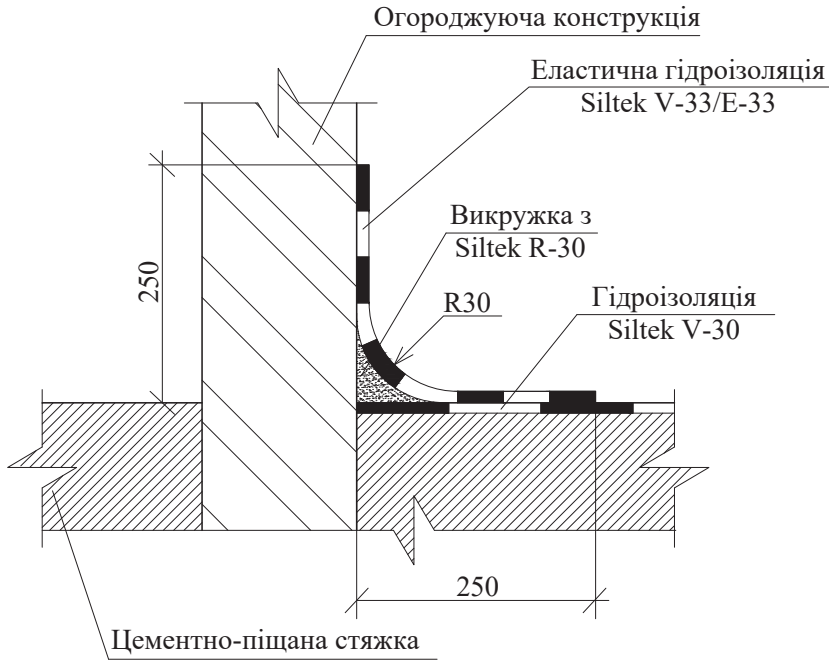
Схема влаштування гідроізоляції на стиках конструкцій
